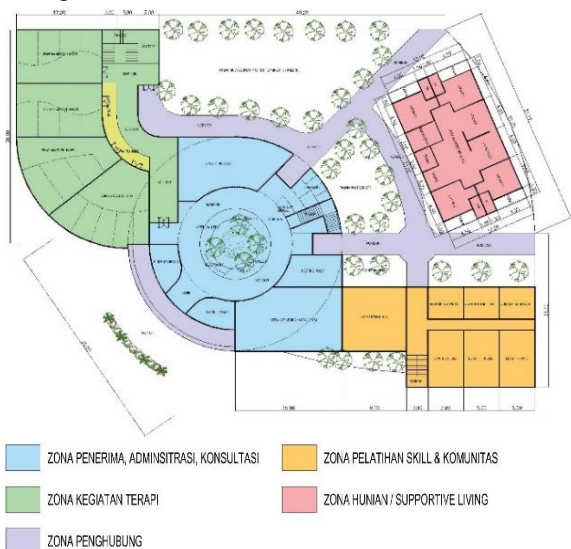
Block Plan (sumber : Penulis, 2024)
